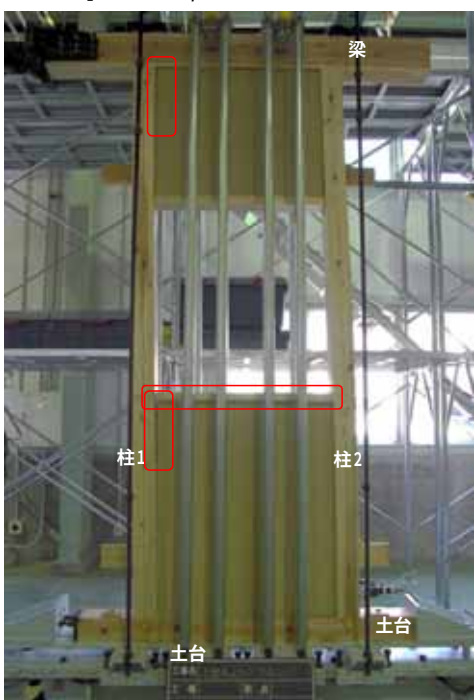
中塗側 1/50rad 垂れ壁・腰壁の軸組みとのひび割れ拡大
